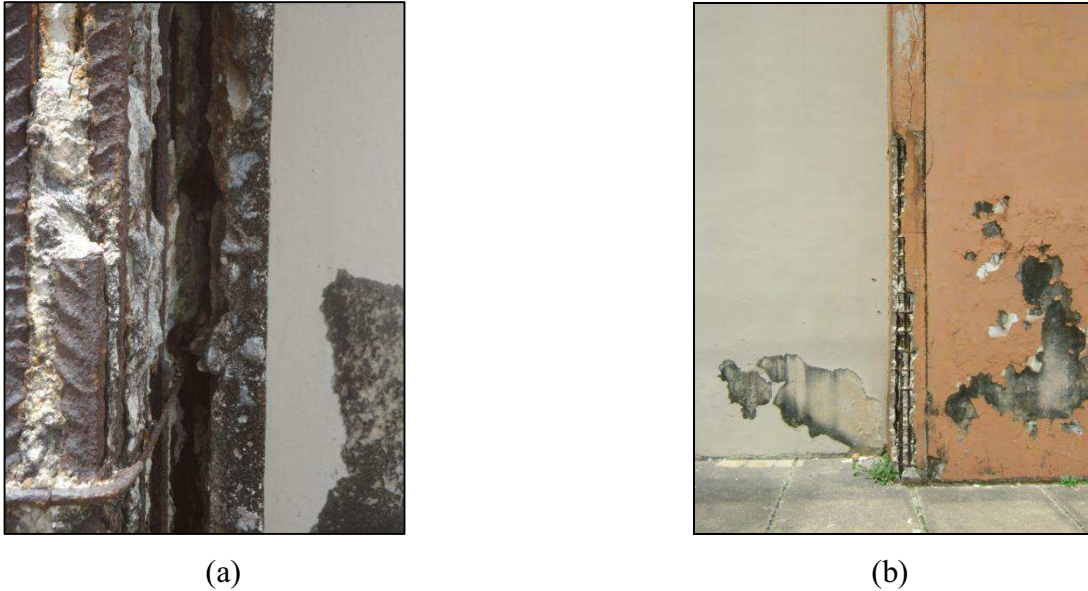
(a) Detalhe do descolamento da camada revestimento em relação à armadura no P19 e (b) região com armadura exposta no P20.
